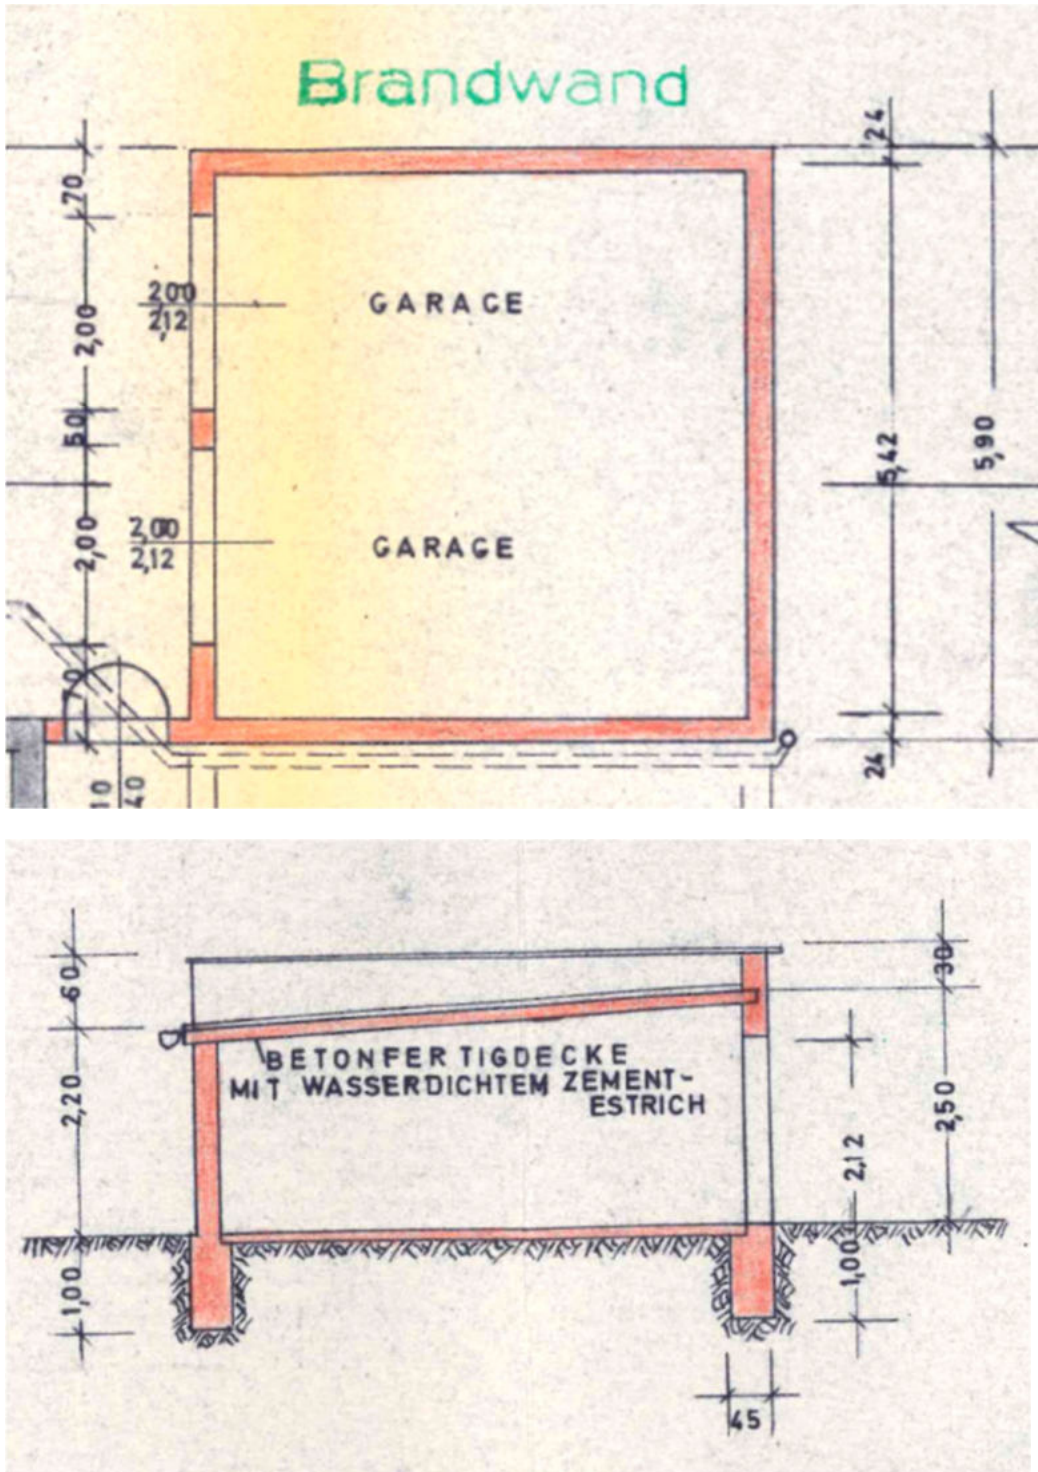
Grundriss Erdgeschoss (ohne Maßstab); Quelle: Bauakte Wohnhausneubau 1968; Nordpfeil d.d. SV
